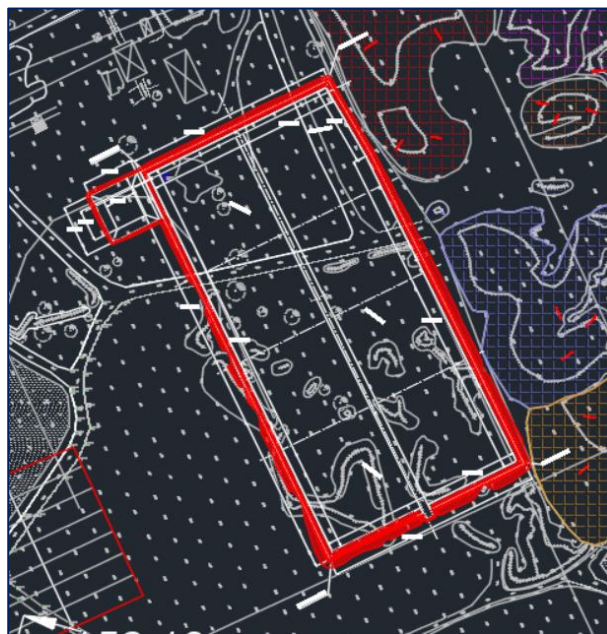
Extrait du plan projet de la plateforme Sud (source : Tractebel Engie)
